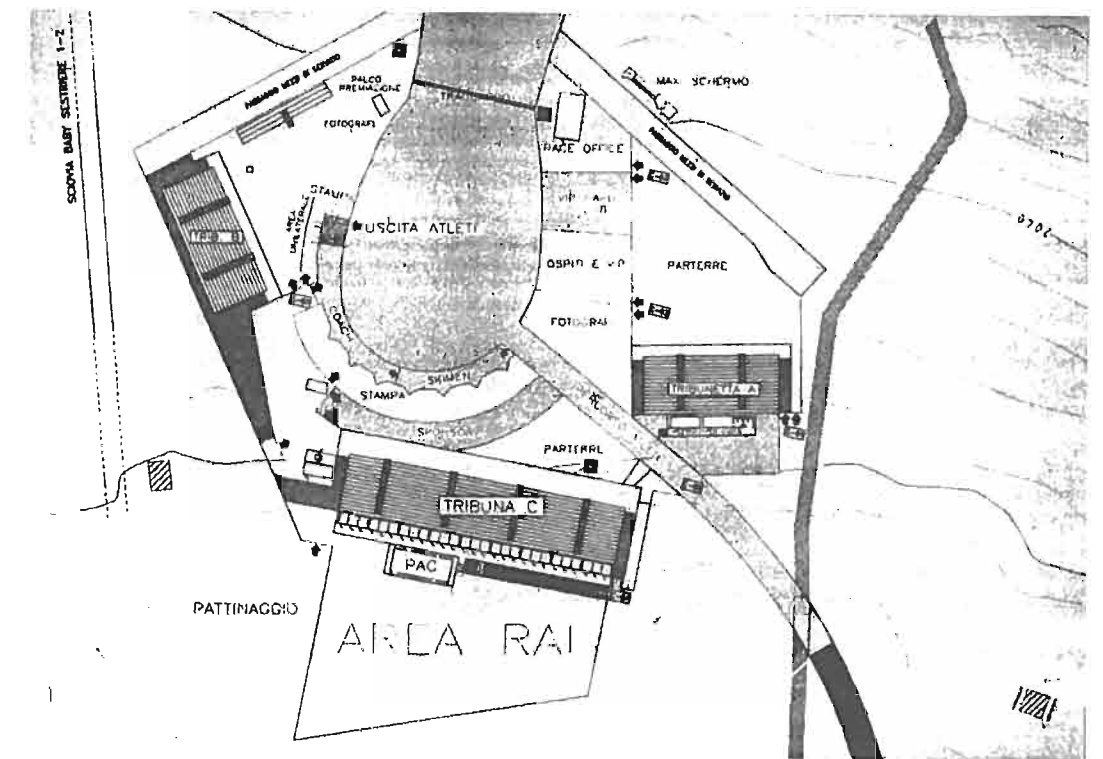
Pianta dell'area traguardo di Sestriere.
